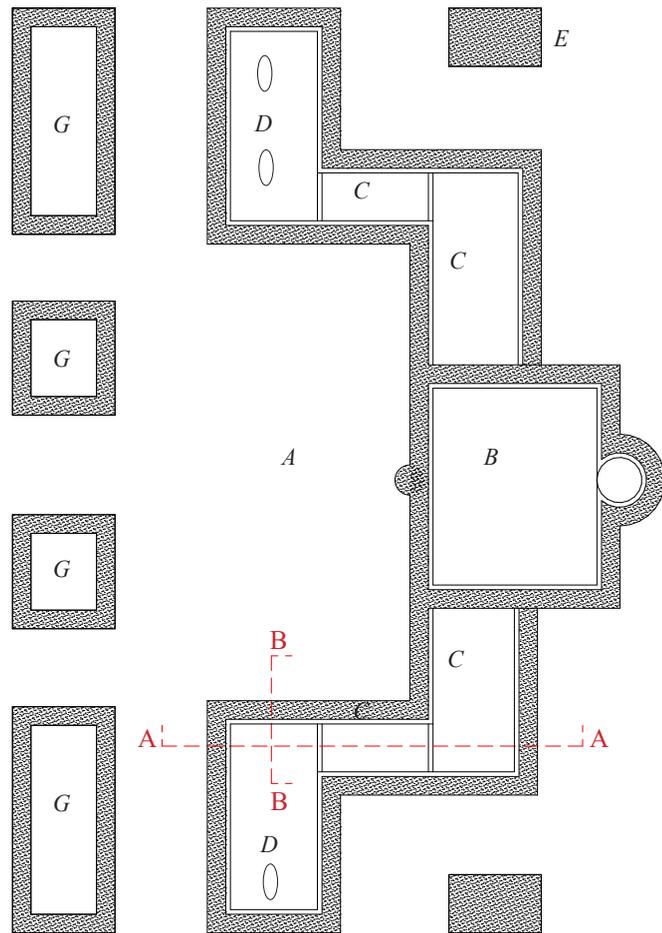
Grundriss 1:10000, gezeichnet nach Charles Fourier; Plan eines Phalanstère (Fourier 1848, 142), Vgl. Doll 2013, 19.
